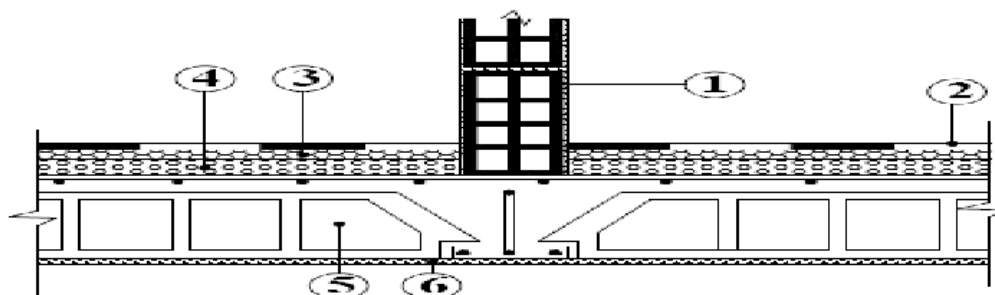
Coupe verticale d'un plancher d'étage courant.
